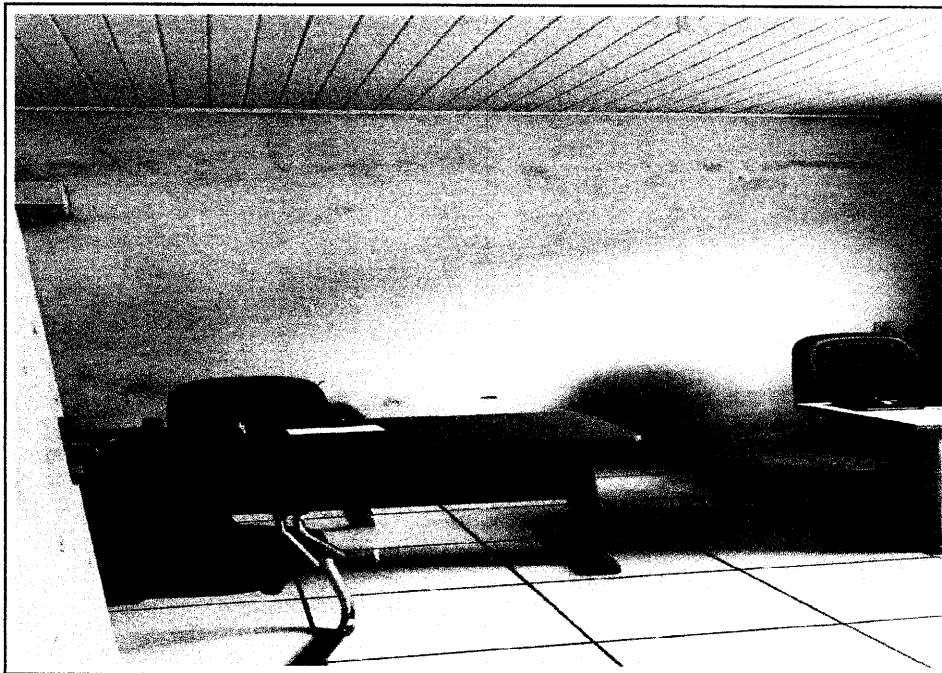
SALA DO SECRETÁRIO DO MEIO
